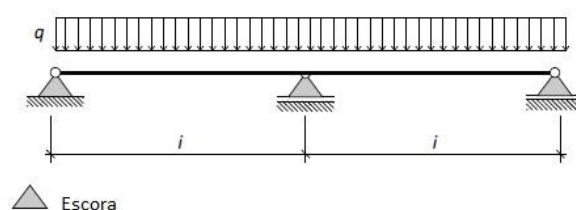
Esquema estático para o dimensionamento de travessas e apoios.
